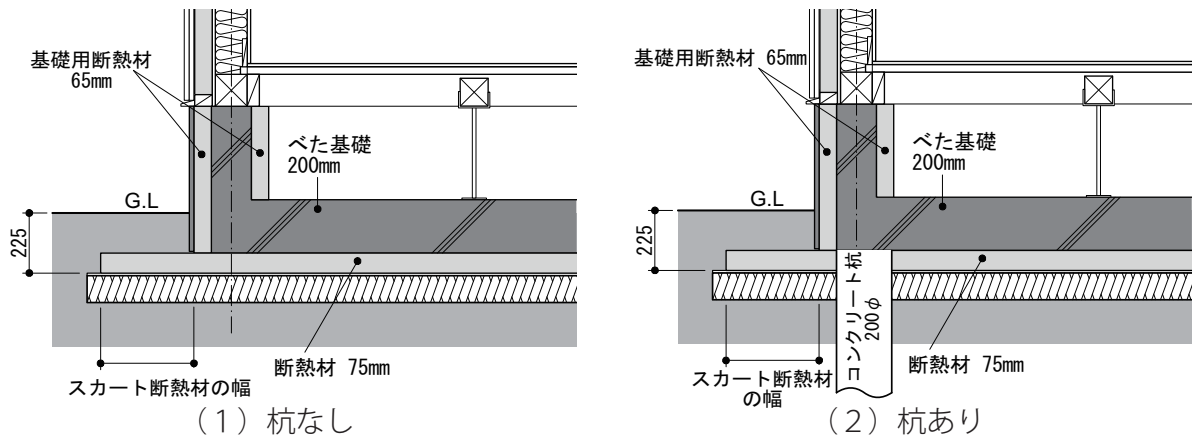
スラブ下に地盤断熱材を施工するべた基礎（べた基礎スラブ下断熱材厚さ 75mm）
